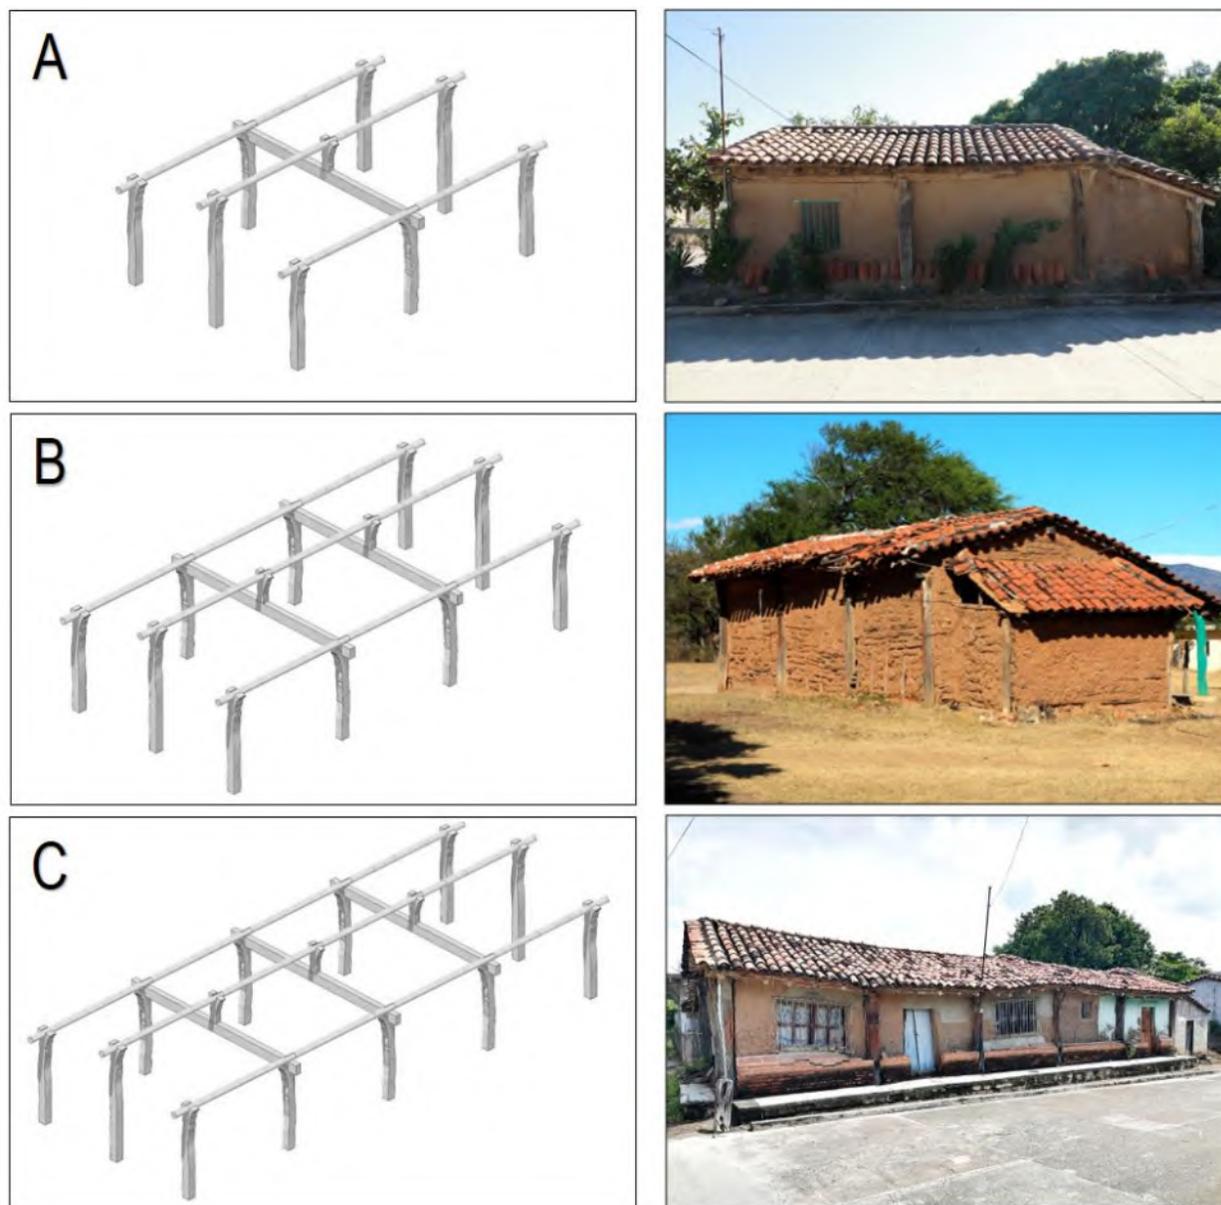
Viviendas de distinta extensión: A) de una plancha, B) de dos planchas y C) de tres planchas o más. Fuente: elaboración propia. Fotografías del autor, 2022.
